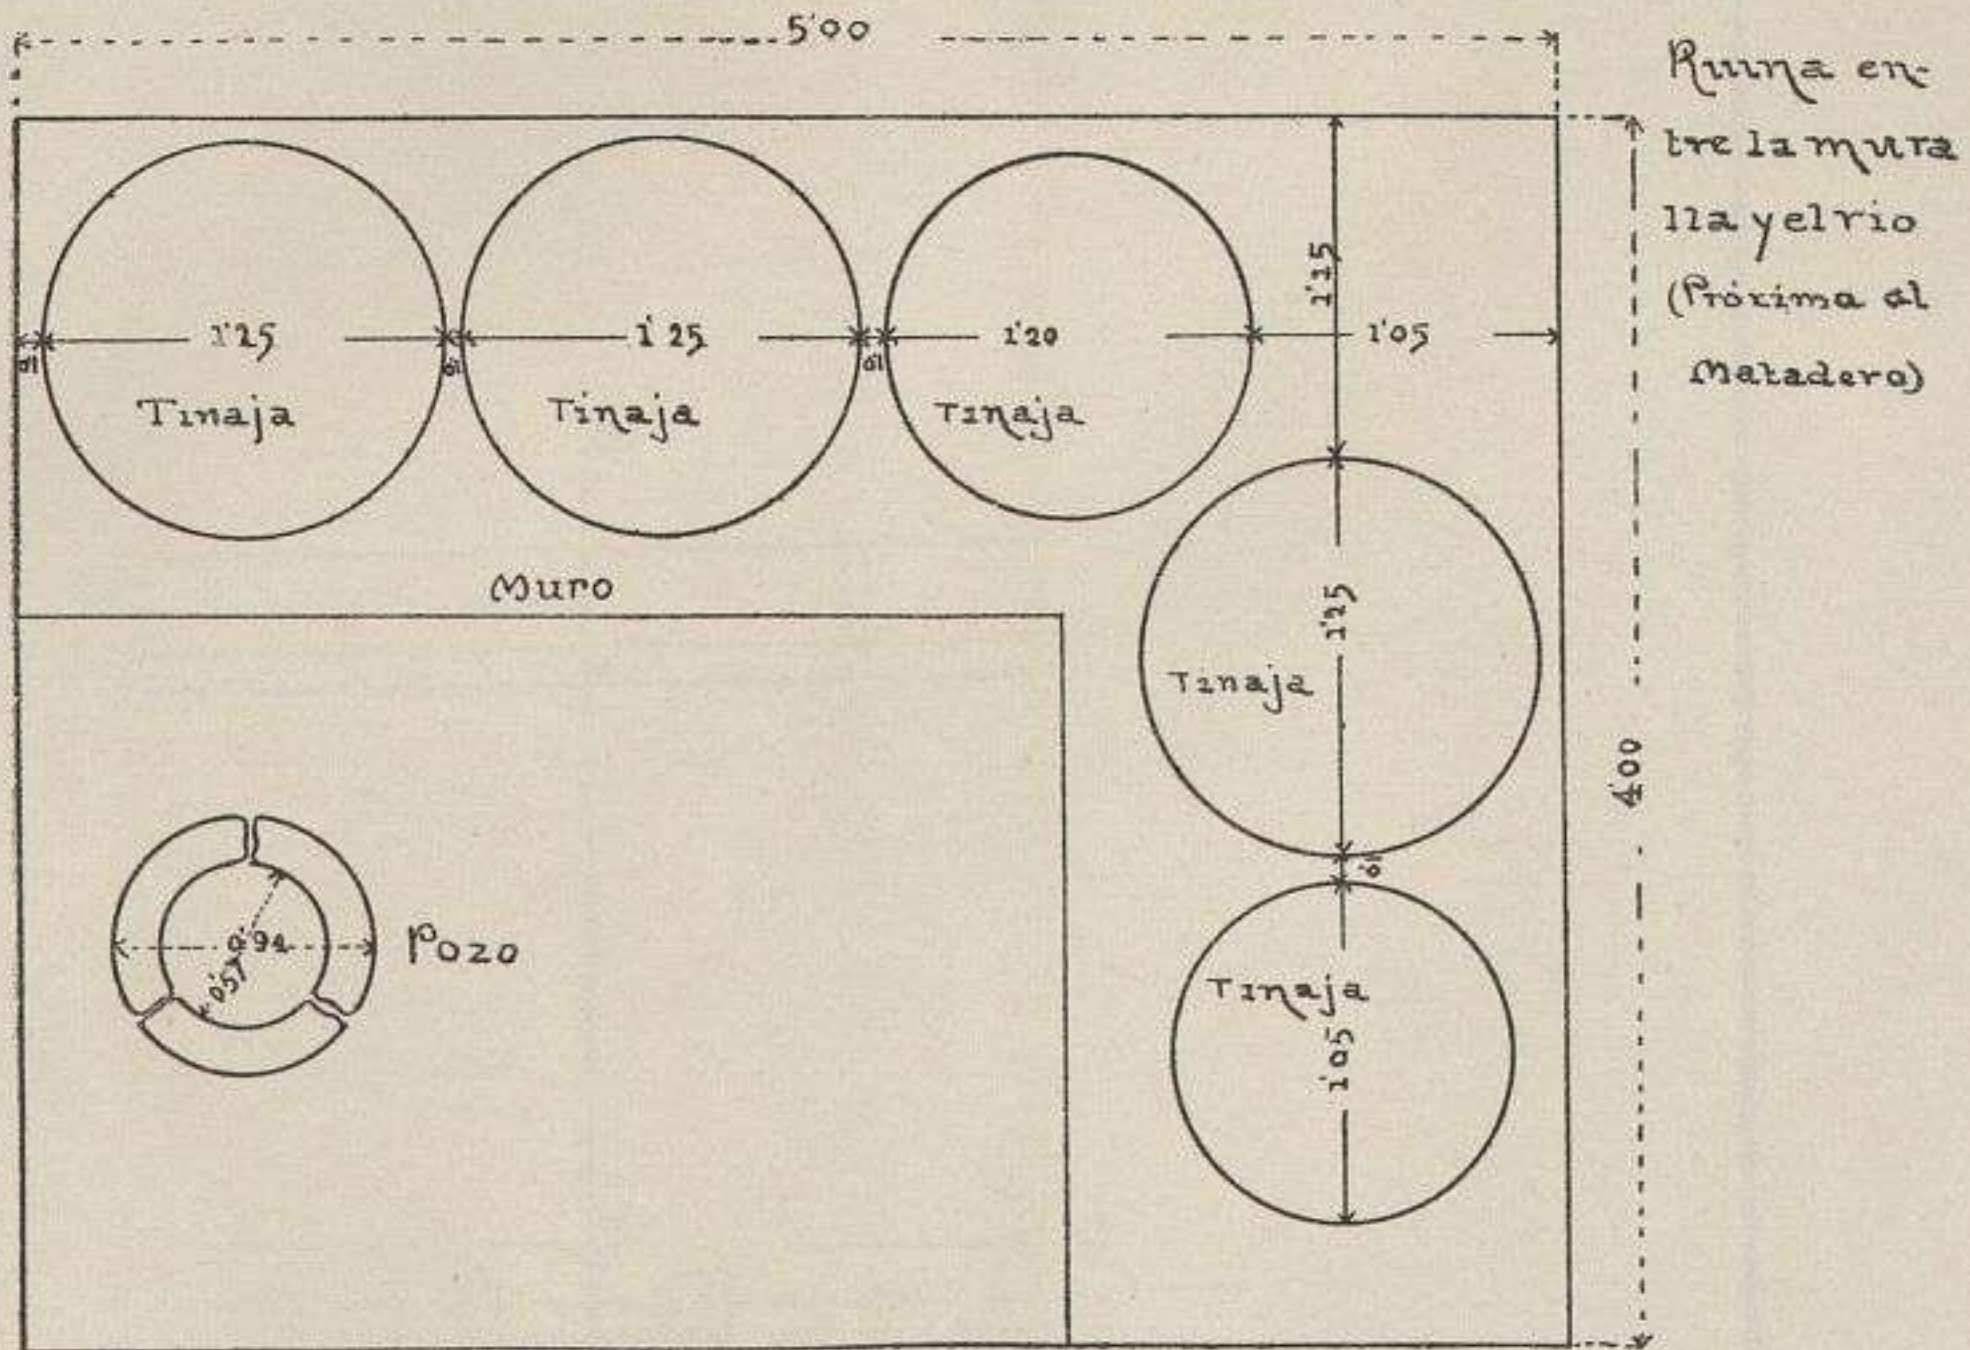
^a Croquis de la planta de un establecimiento industrial.
